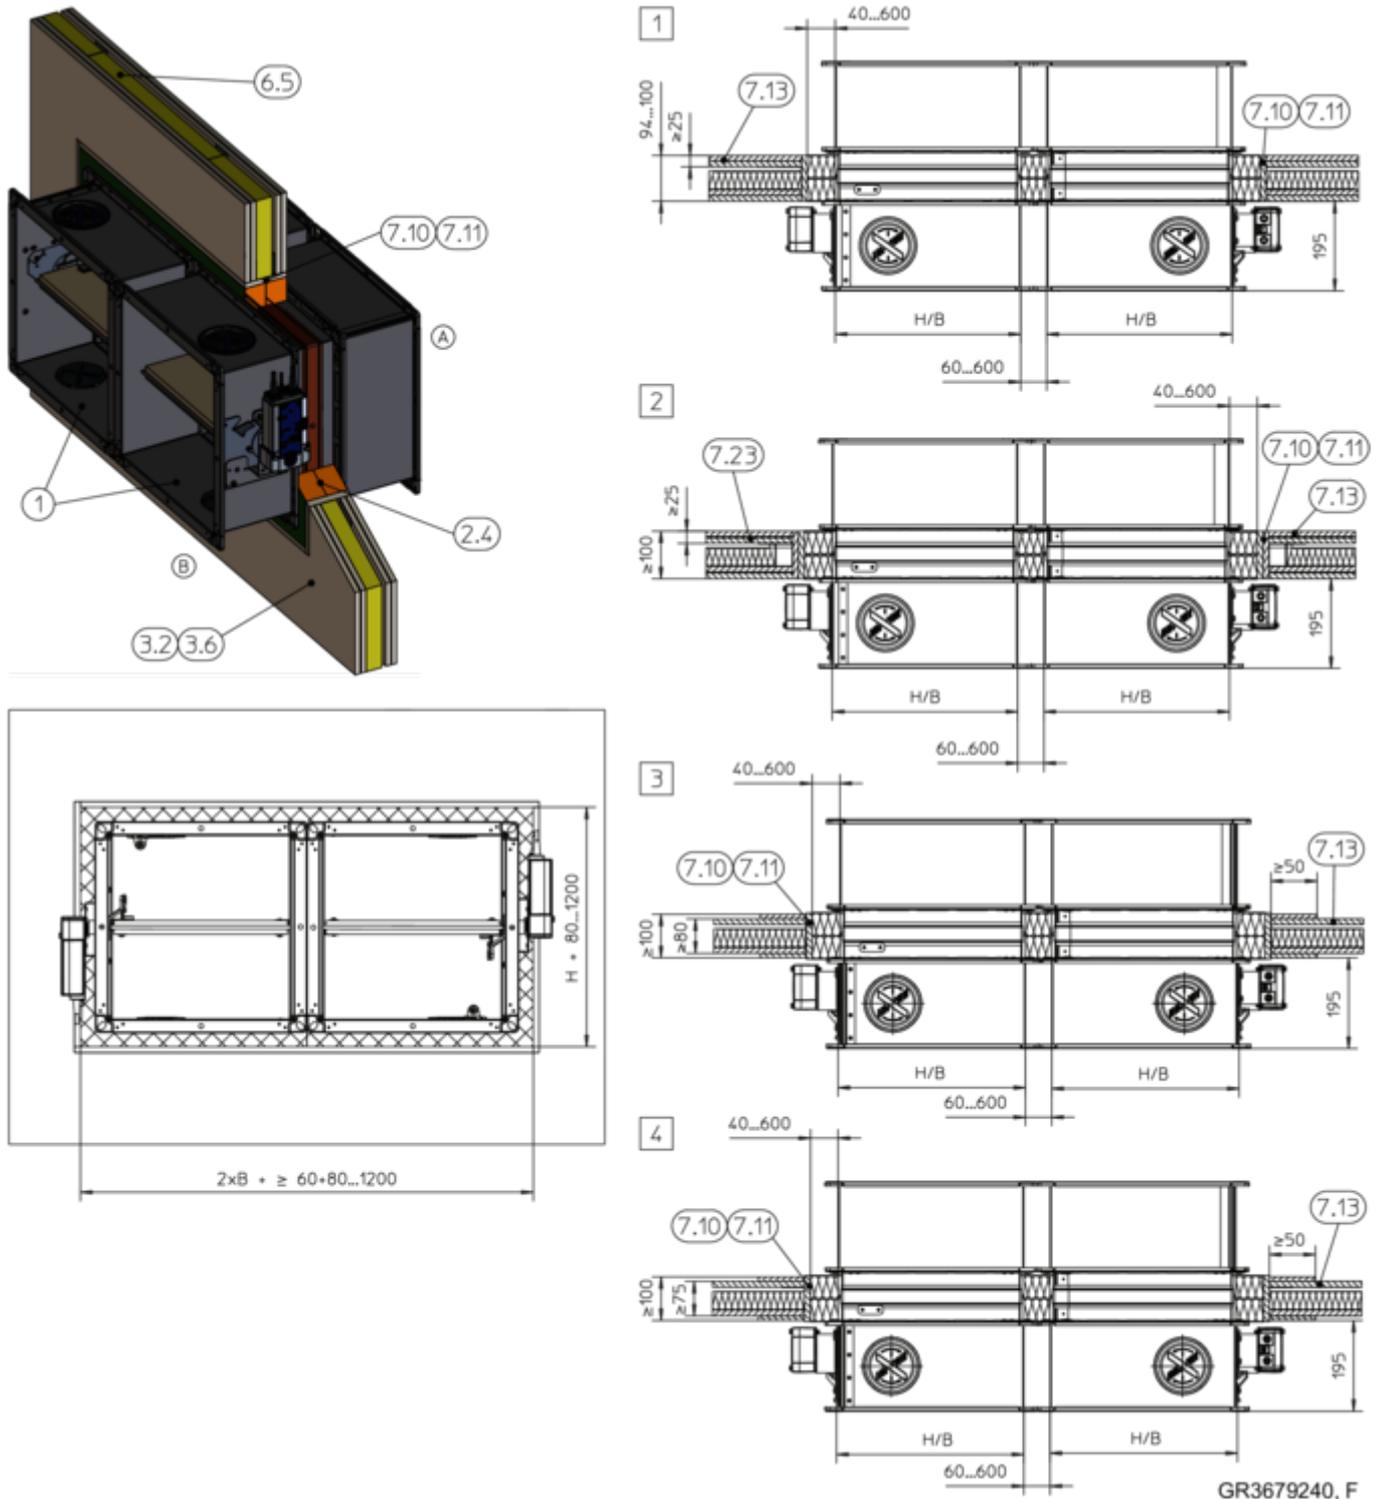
Montagem a seco numa parede divisória leve, com placa de enformagem contra incêndios, flange a flange. A ilustração apresenta uma montagem lado a lado (aplica-se também à montagem de registos um em cima do outro)
